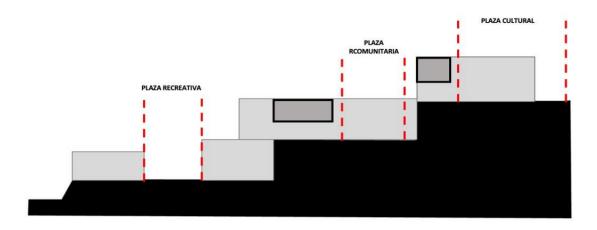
Esquema en corte de propuesta arquitectónica - Elaboración propia
